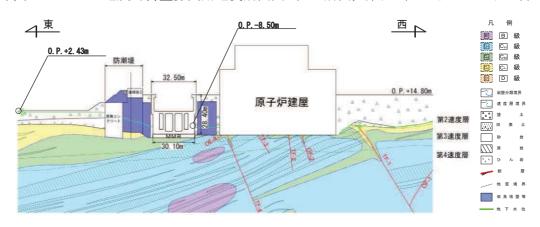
海水ポンプ室 地震時荷重算出用地質断面図 (B-B 断面, 東西 (補機ポンプエリア))
